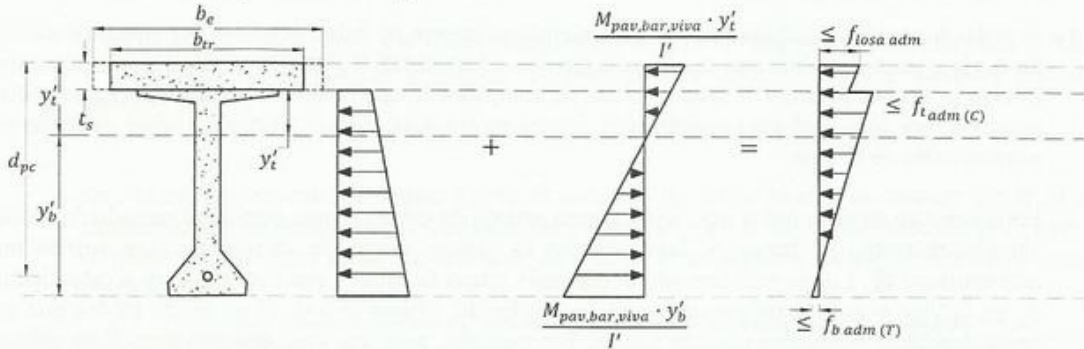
Esfuerzos en la viga en las diferentes etapas constructivas y de servicio
